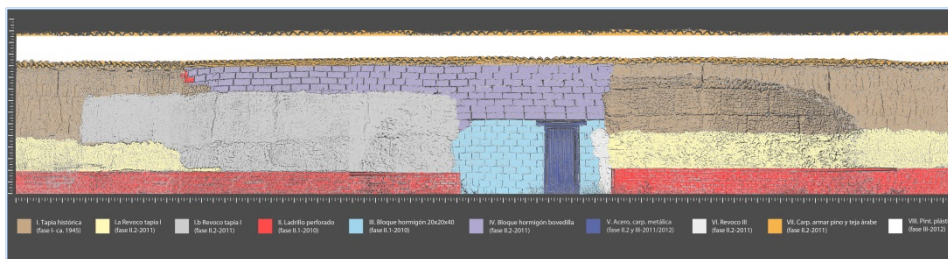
Fases y materiales constructivos del palomar. Fachada exterior [©Javier Pérez Gil]
